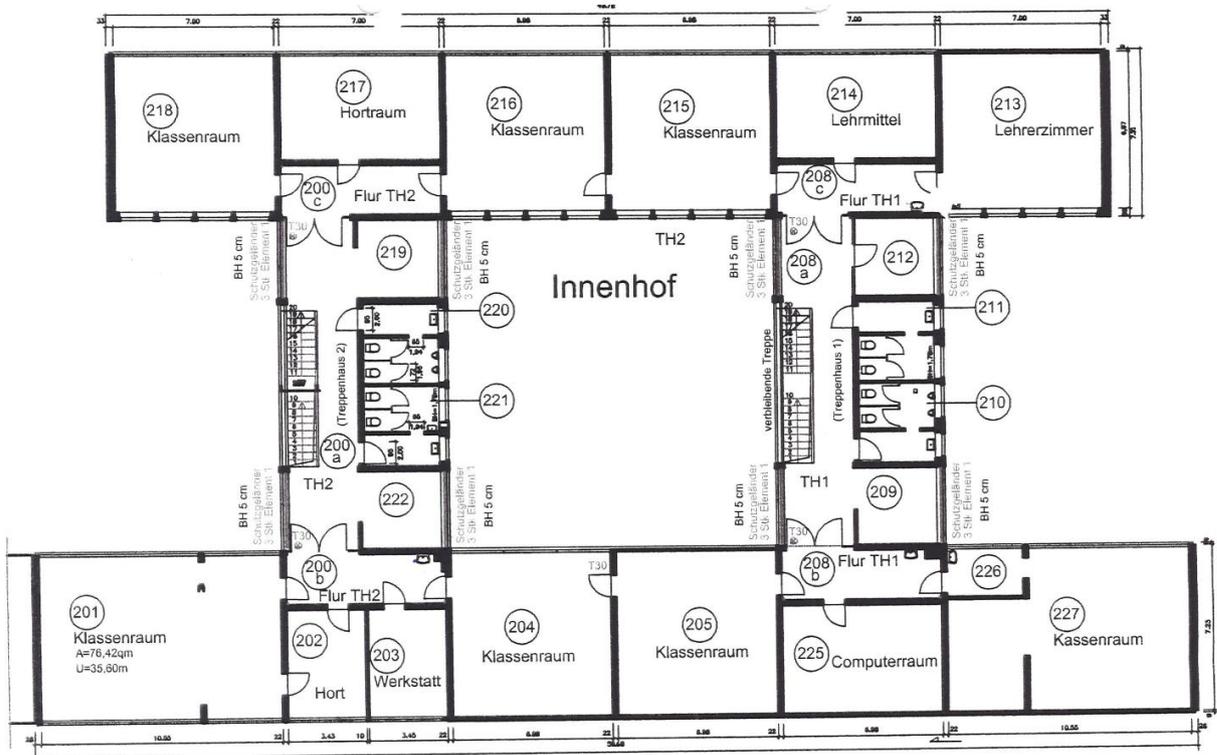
1. Bauabschnitt, Obergeschoss Schulgebäude
